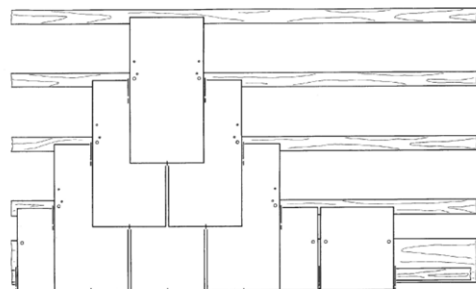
Riešenia odkvapu presahujúce krytinou s podoprením a krycou plechovou lištou
